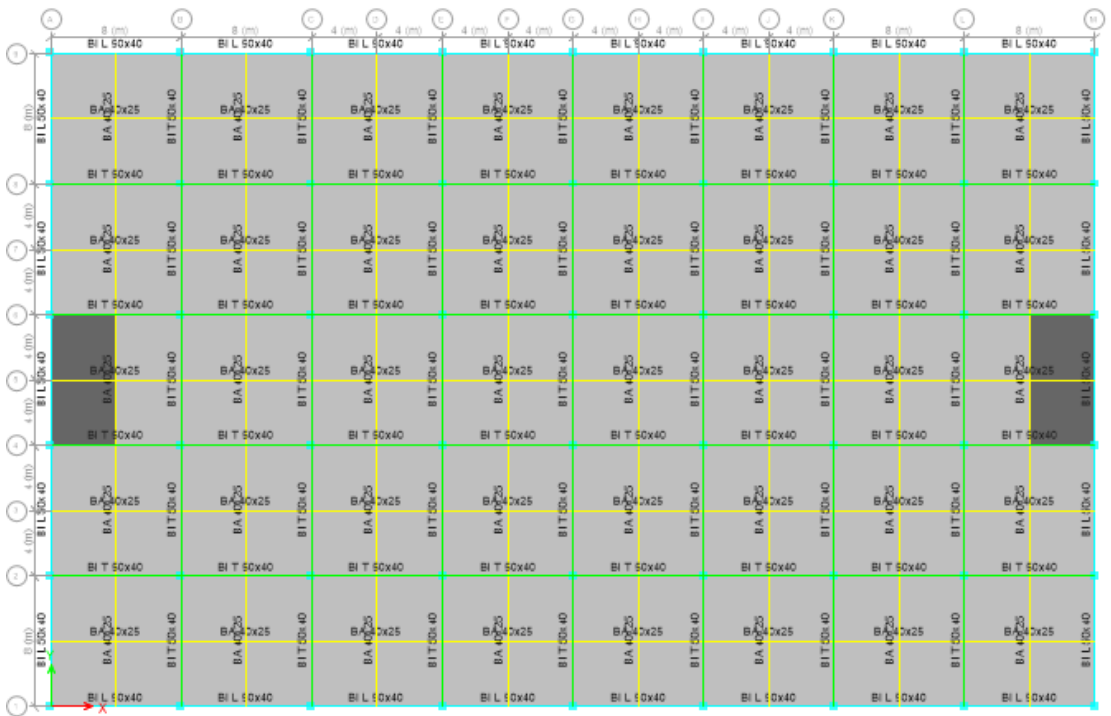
Denah Model 1 Lantai 8 Tanpa *Seaworld
